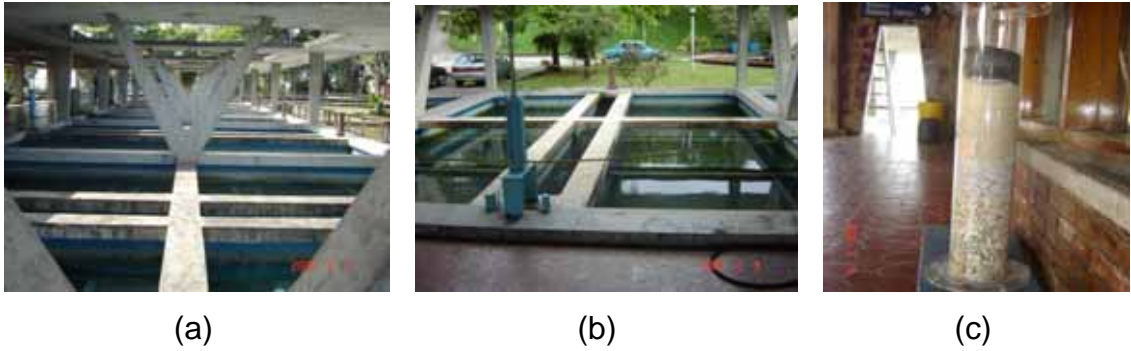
(a) Galería de filtros de la planta la flora; (b) Filtro planta la flora; (c) filtro modelo para ver el lecho filtrante.
